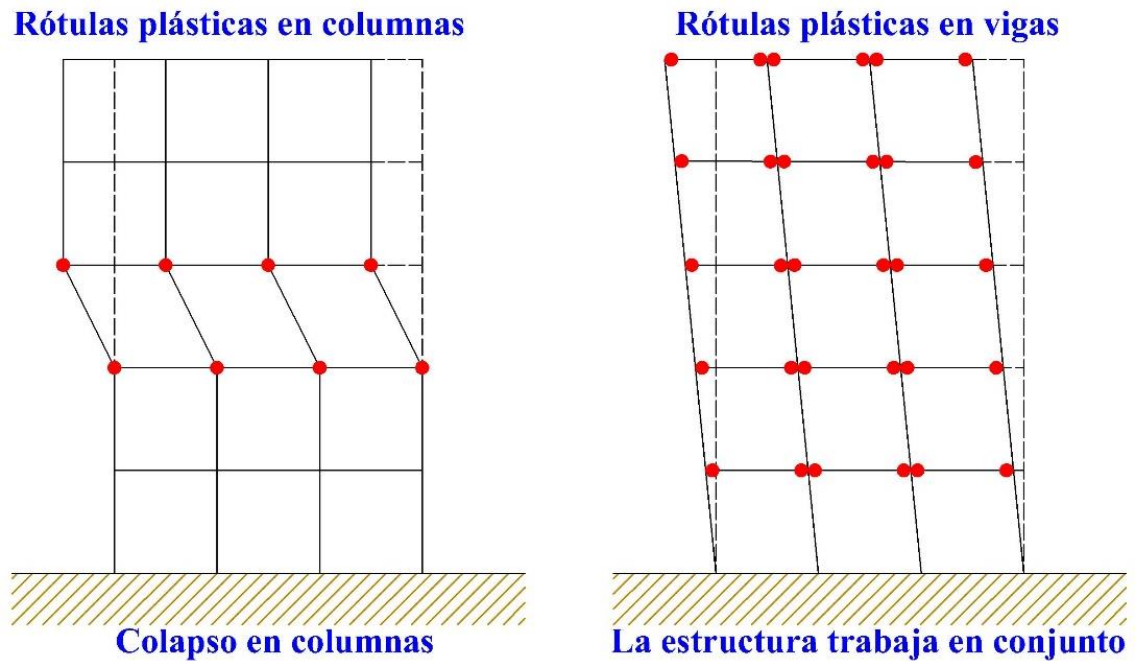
Ubicación de rotulas plásticas en columnas y vigas.
